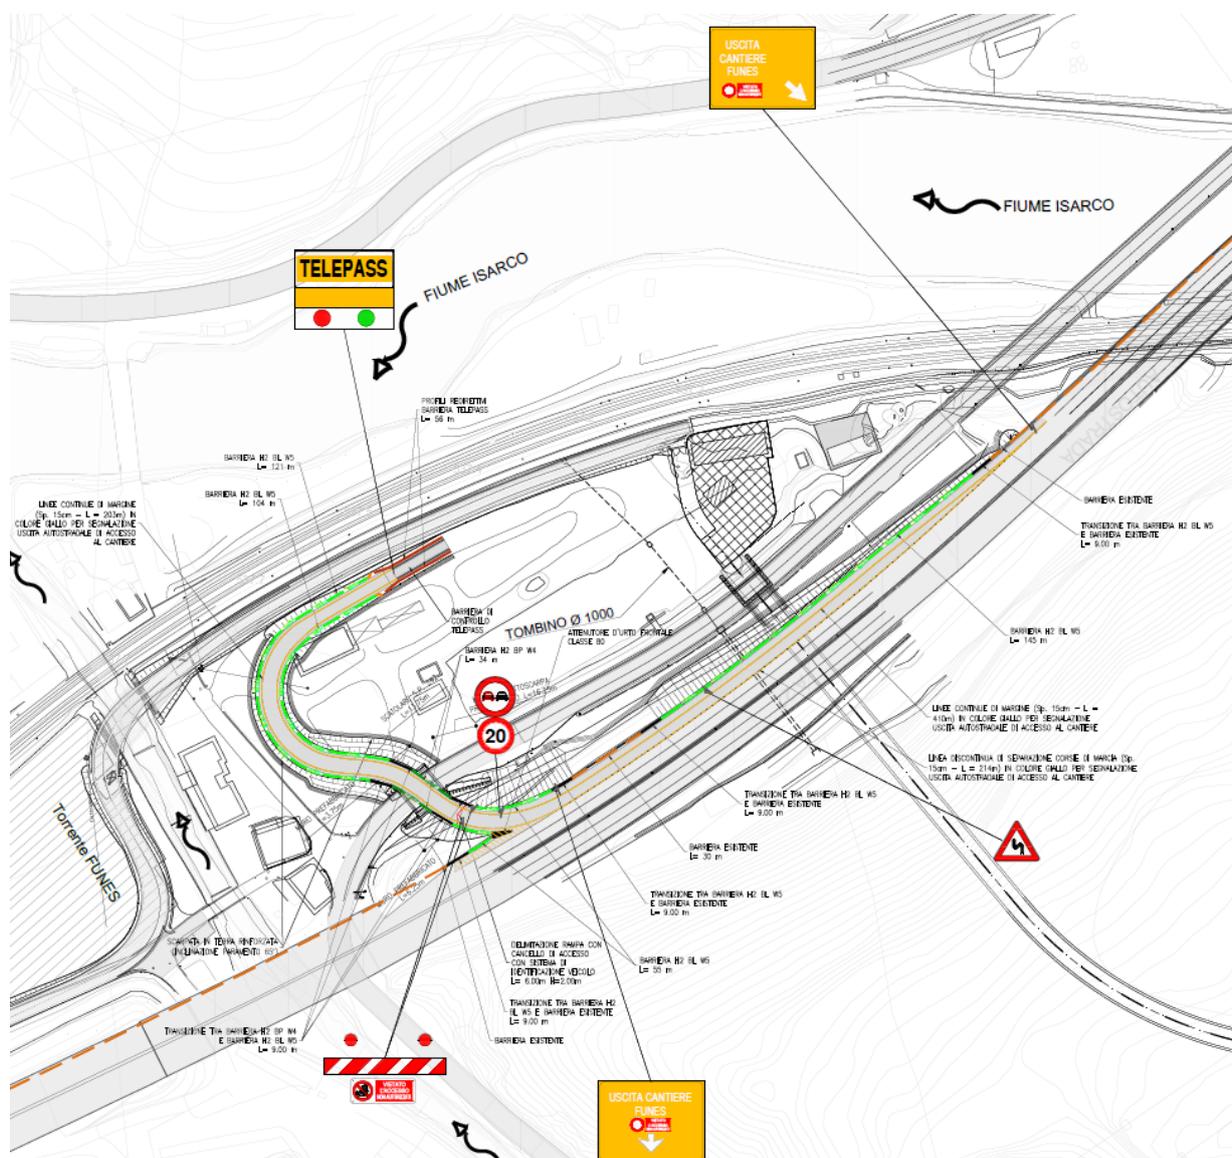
Stralcio planimetrico configurazione di progetto barriere di sicurezza NV043
